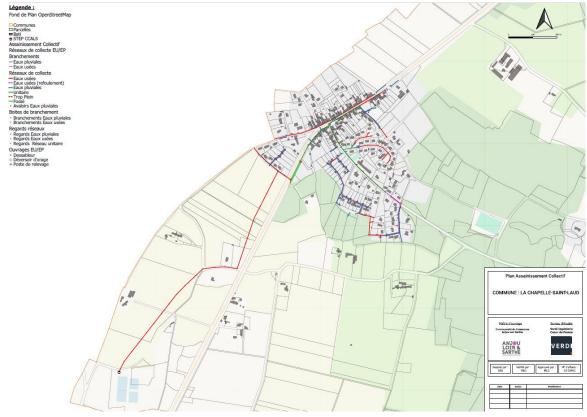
Plan de fonctionnement du réseau d'assainissement du secteur Bourgneuf
